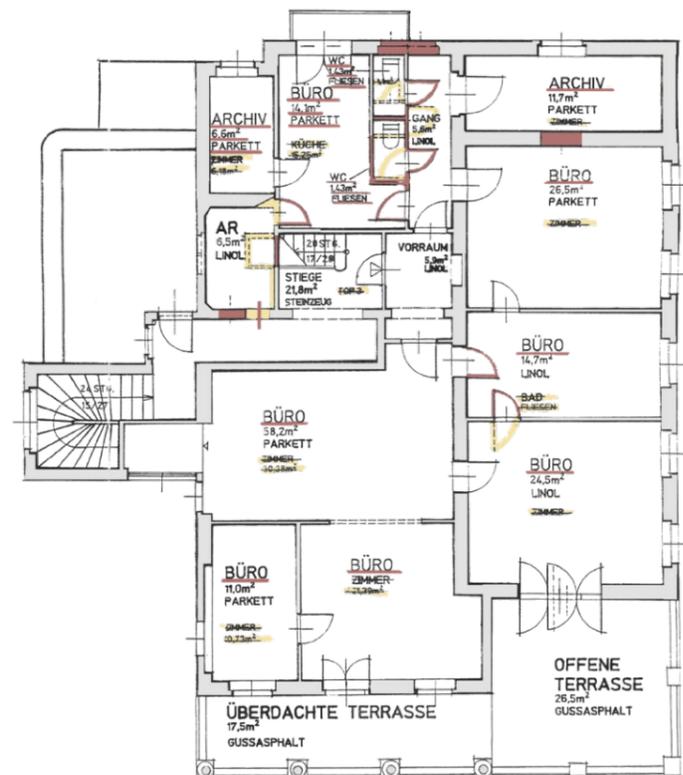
Grundriss Obergeschoss 1994.
